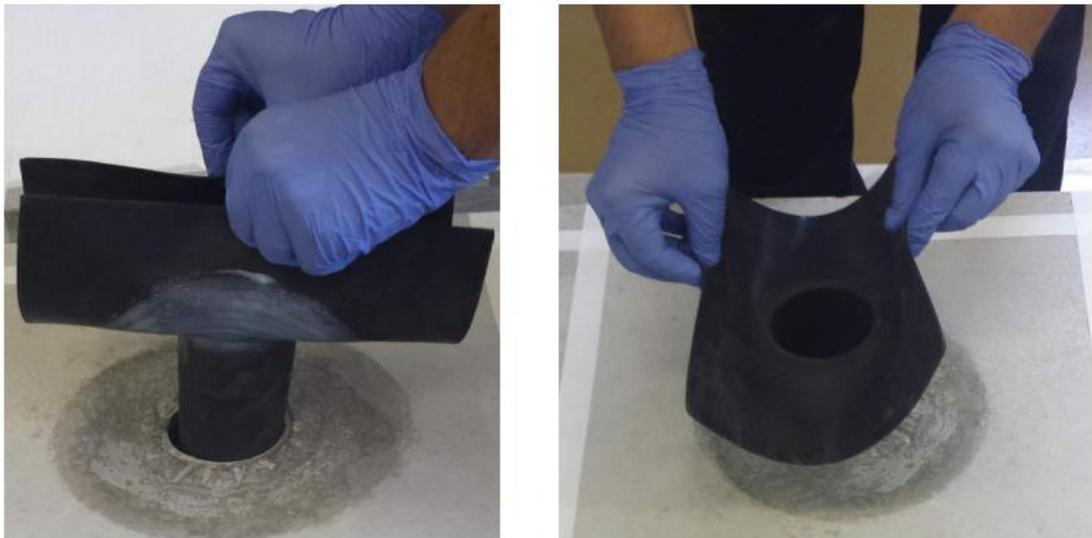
Ralo pré-fabricado usado na complementação da impermeabilização (VIAPOL, 2023).
